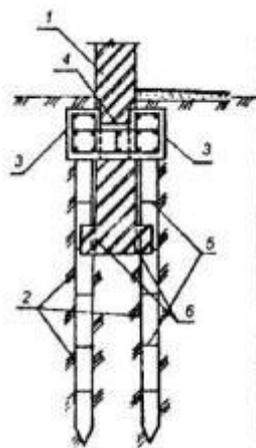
1 - усиливаемый фундамент; 2 - звенья составных железобетонных свай; 3 - железобетонные балки, устраиваемые вдоль стены здания; 4 - железобетонные монолитные перемычки, устраиваемые с шагом 1-1,5 м; 5 - стыки свай; 6 - сколотая поверхность фундаментной плиты.
